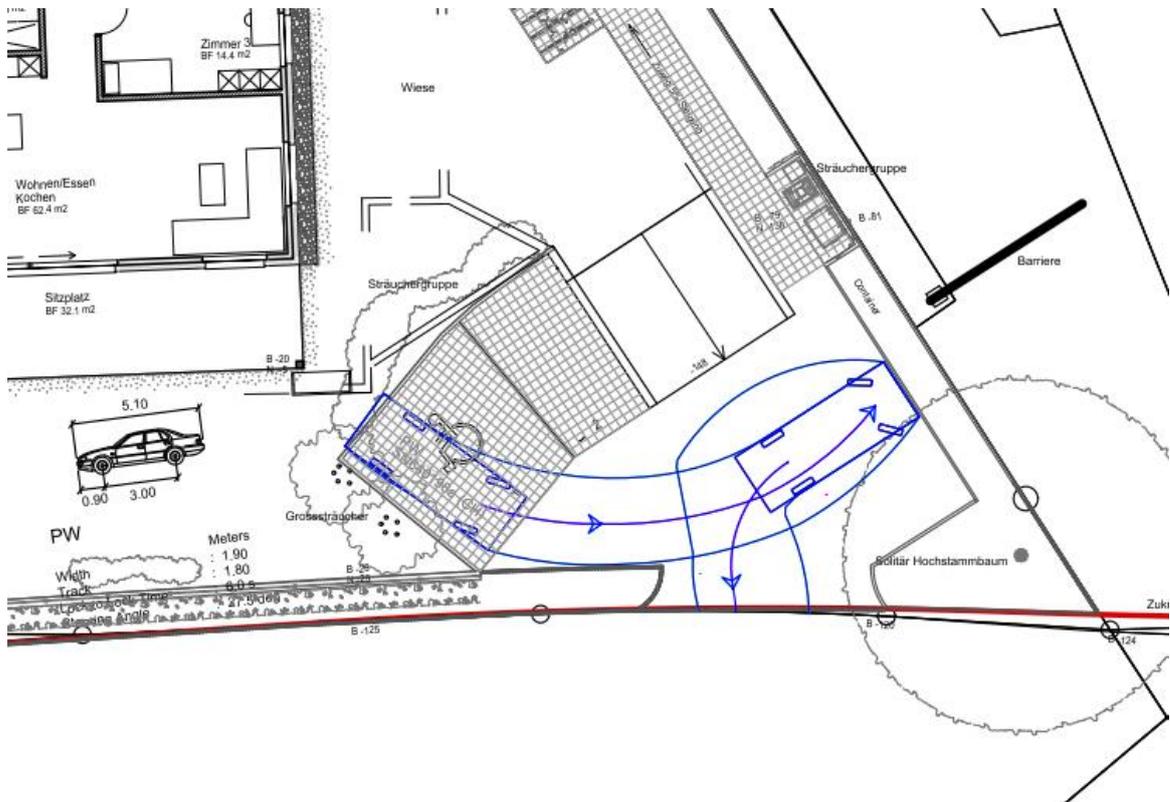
Nachweis Wendungen auf dem Grundstück
